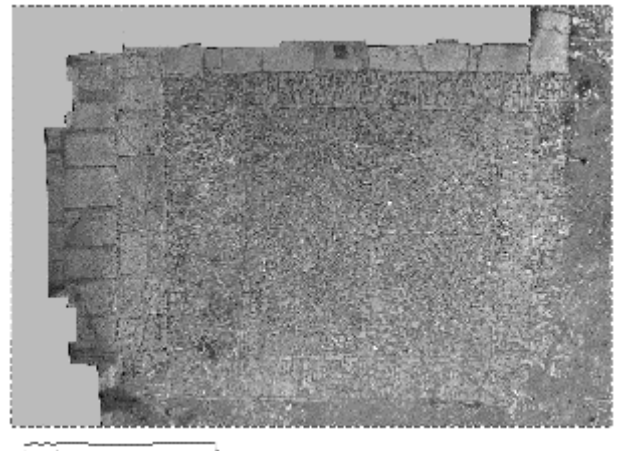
Imagen del levantamiento del sector 8 (Zona de acceso a la iglesia).
